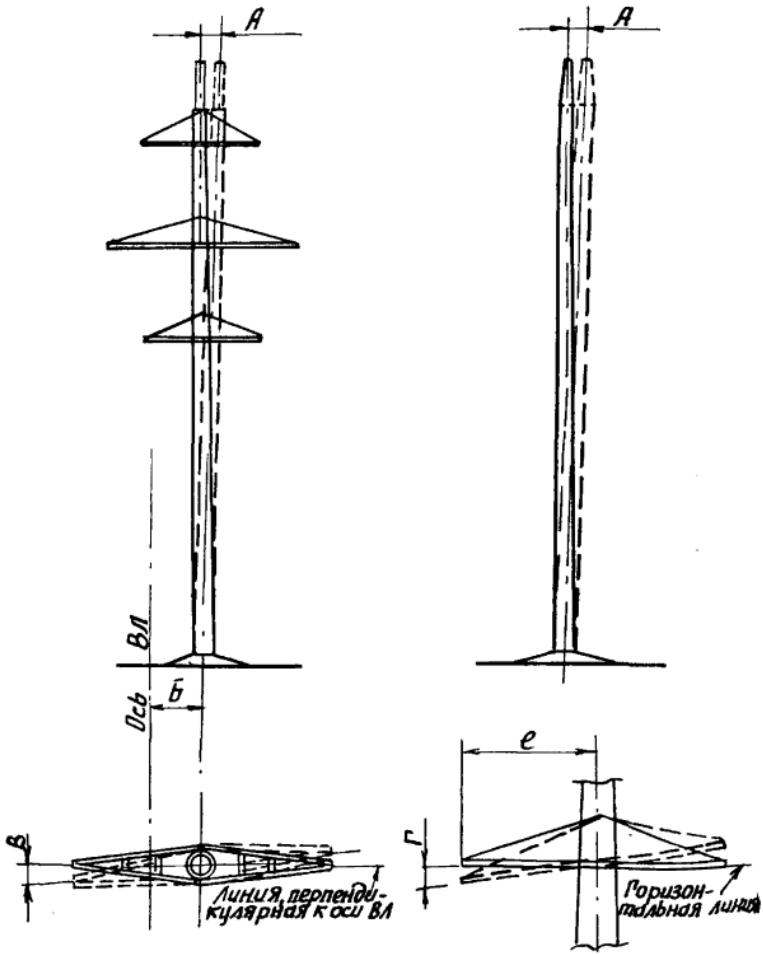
Нормы и допуски на установку одностоечных железобетонных опор
